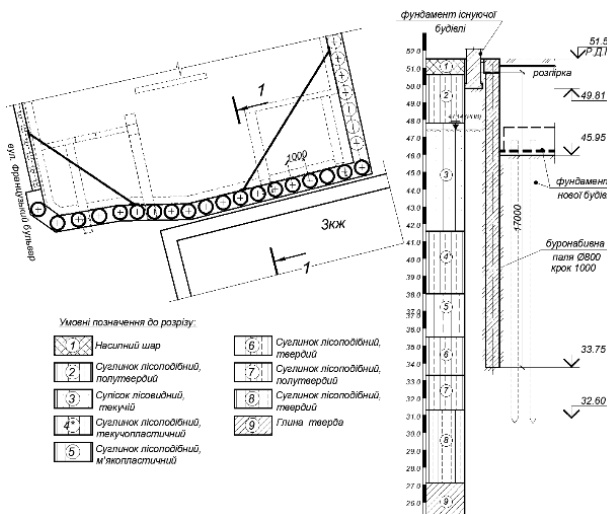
Фрагмент схеми будівельного майданчика по вул. Французький бульвар, 3
